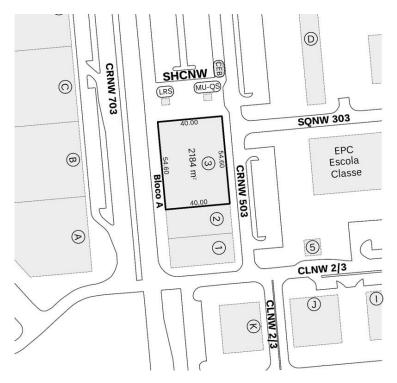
Croqui da Situação Proposta. Fonte: MDE 200/2024
